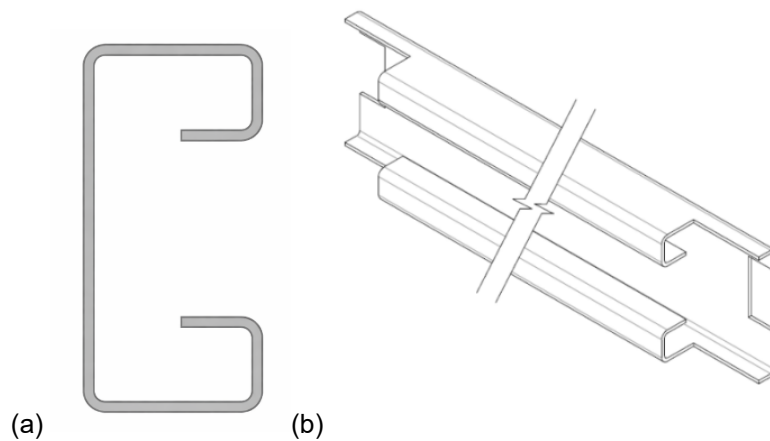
Execução do reforço do perfil transversal do sistema de piso
